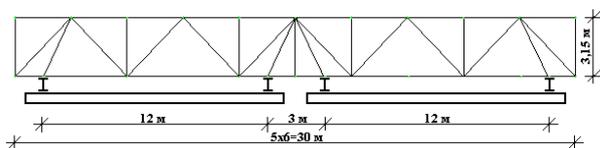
Схема фермы пролетом 30 м и подвесных кранов
